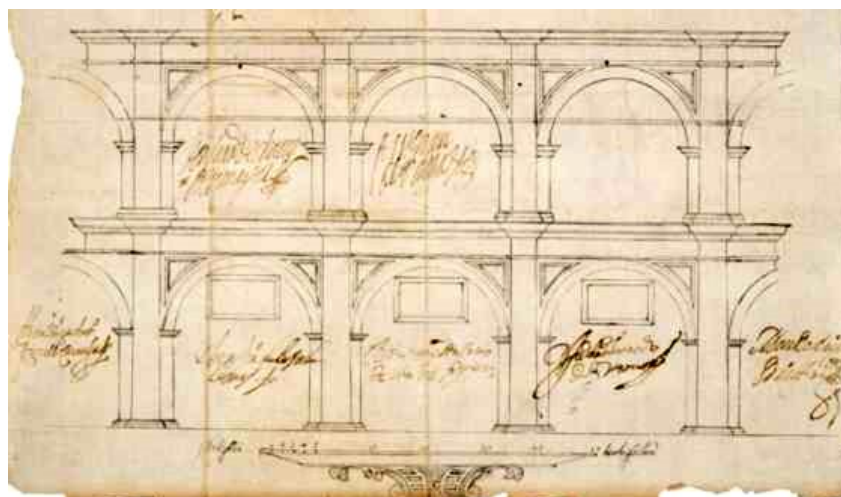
Plano del alzado de un patio de comedias en Badajoz, 1669 (AHPB).
